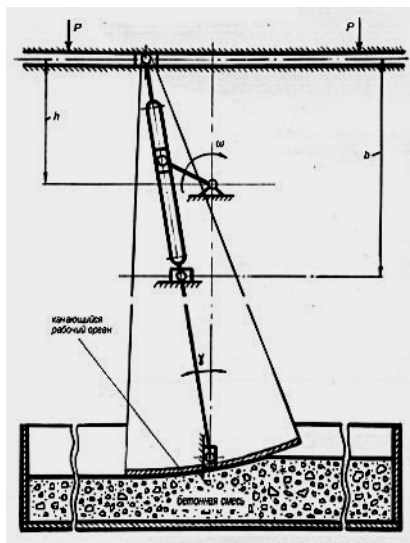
Принципиальная схема бетоноуплотняющего оборудования с КЦРО
